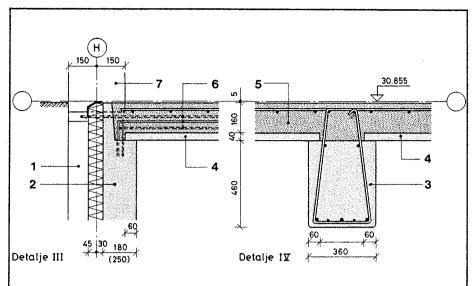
Samlinger ved dæk over kælder, detalje III og IV, lodrette snit 1:20. 1 kældersøjle, 2 kældervæg med isolering, 3 bjælkeelement, 4 Filigranplader, 5 armeret overbeton, 6 forankringsarmering, 7 etagesøjle.
